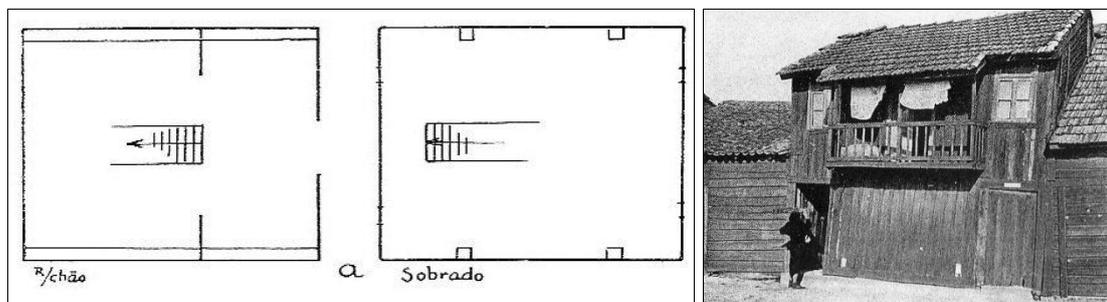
Planta esquemática, Palheiro de Pescadores, Furadouro, Ovar
